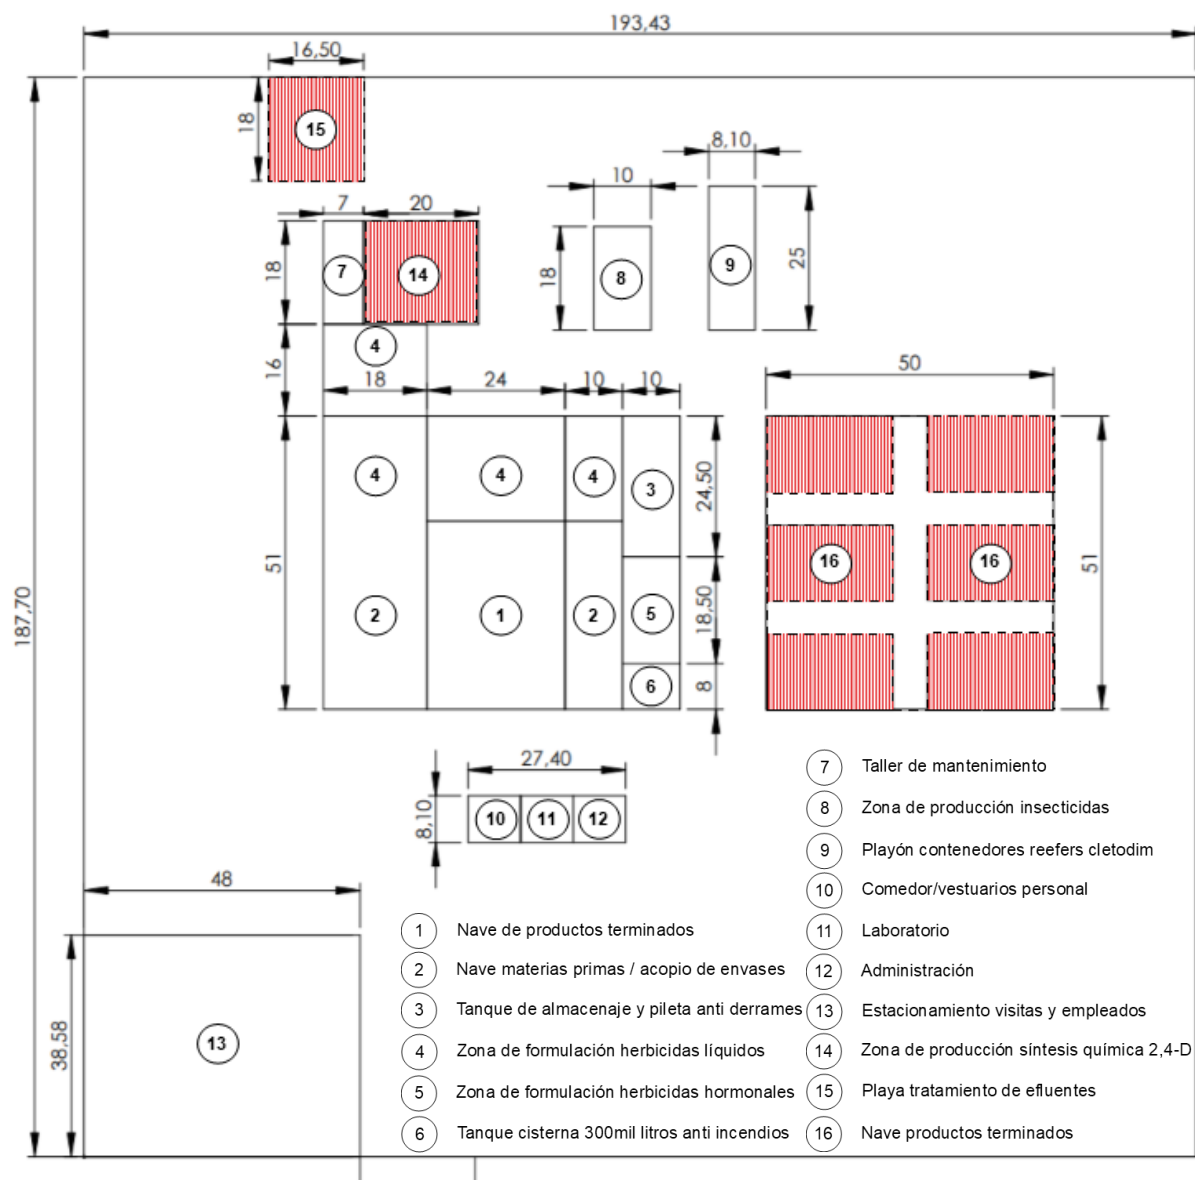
Layout propuesto para la planta de producción de Sigma Agro.
